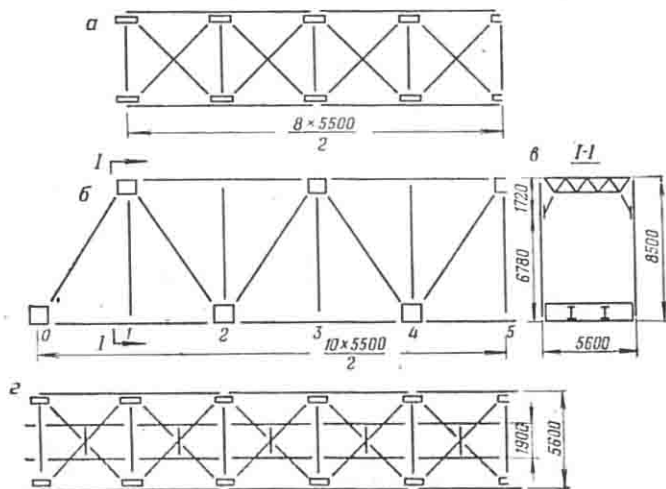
Монтажная схема клепаного сквозного пролетного строения длиной 55 м с ездой понизу под нагрузку Н8 проектировки 1955 г.: а — план верхних продольных связей; б — фасад; в — поперечный вид; г — план нижних продольных связей и проезжей части
